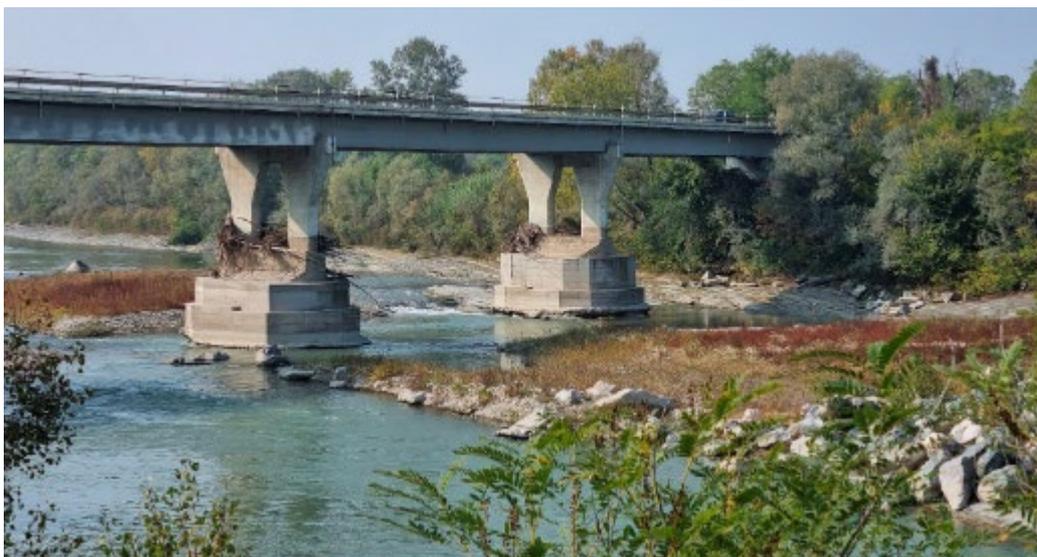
Ponte di Neive. In evidenza l'abbassamento del fondo alveo con messa a nudo delle fondazioni delle pile del ponte, intestate su marna affiorante
